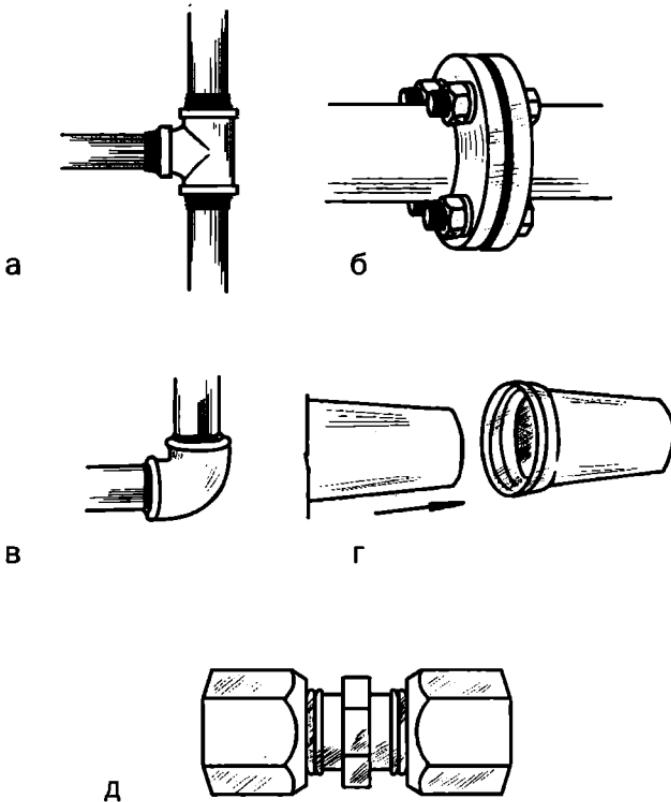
Некоторые способы соединения труб: а — резьбовое; б — фланцевое; в — муфтовое; г — раструбное; д — цанговое
